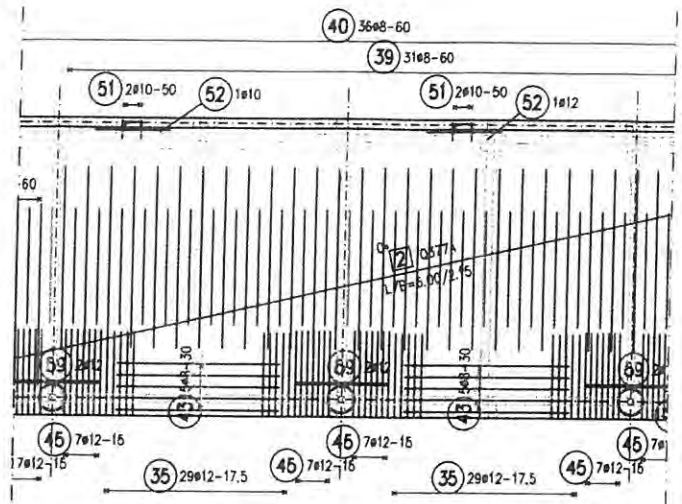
Variante 2: Deckenausschnitt konventionell bewehrter Spannbeton, untere Lage: $d = 25$ cm, Beton C 35/45 XC1, Durchbiegung 3,9 cm
